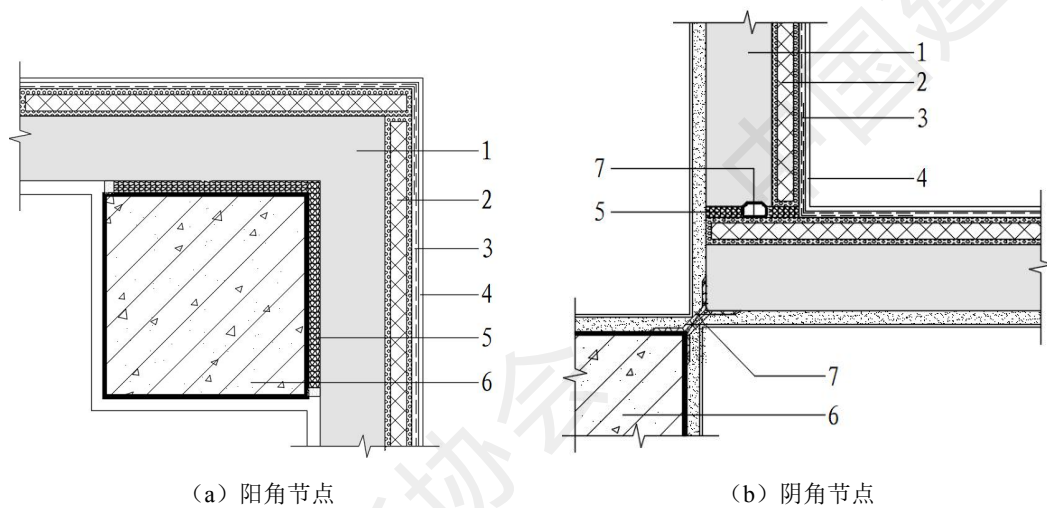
真空绝热预制混凝土保温外挂墙板接缝节点构造示意图
